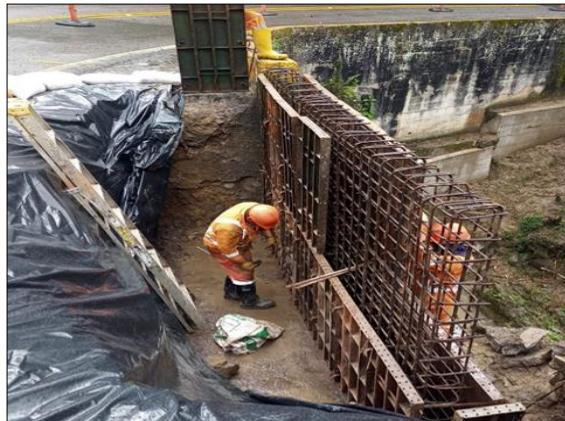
Construcción de muros PR 38+050 al PR 38+070
